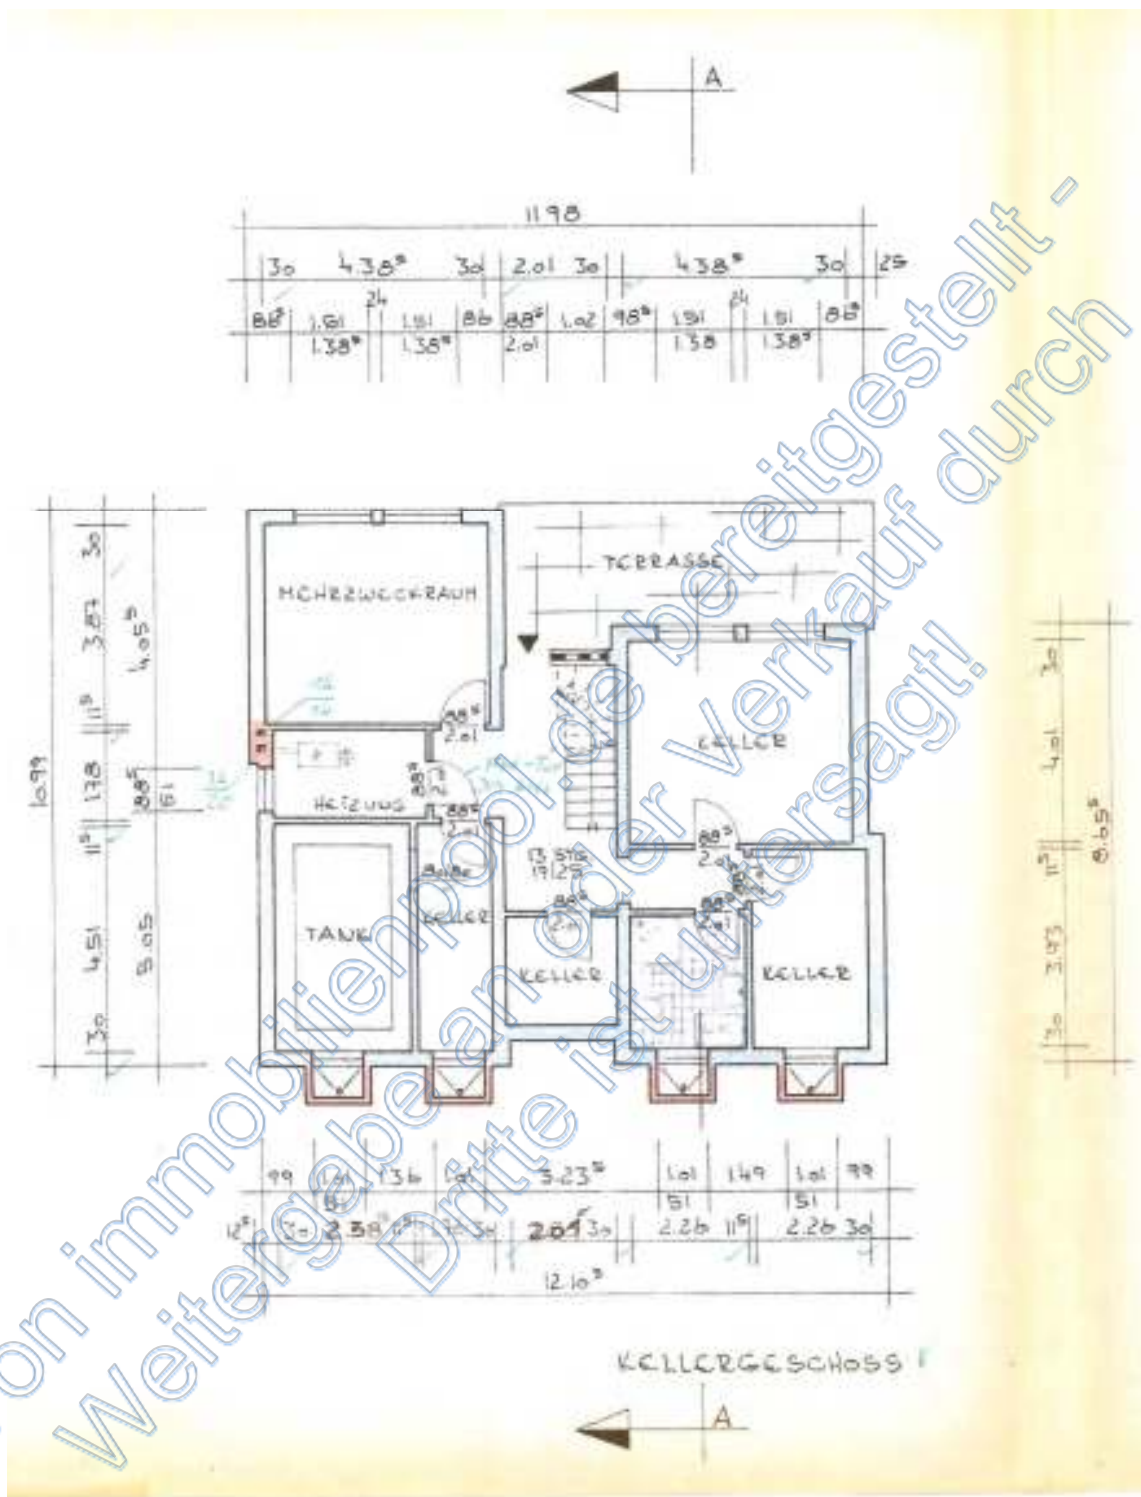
Bauzeichnung - Grundriss, Kellergeschoss
